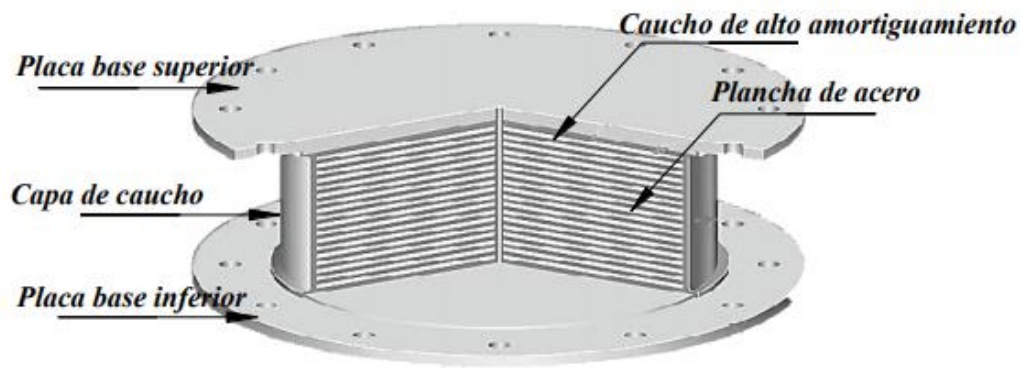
Aislador elastomérico de alto amortiguamiento HDRB (Bridgestone, 2013).
